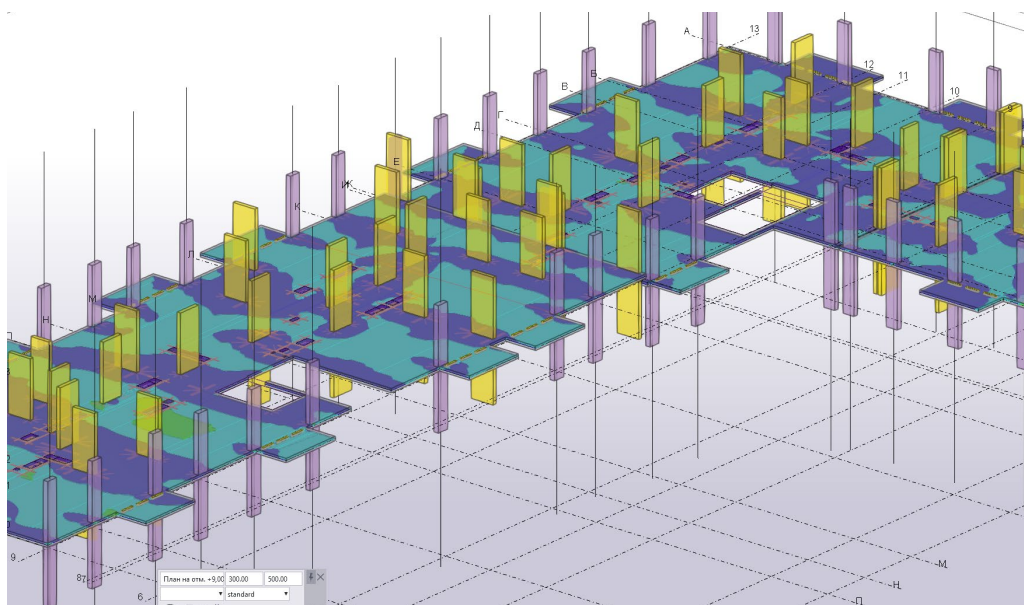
Карта армирования монолитного перекрытия в формате dwg наложена на опалубочную модель в Tekla Structures
